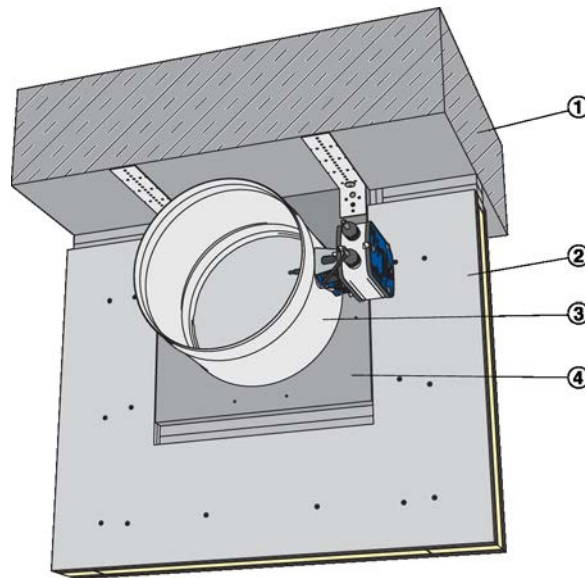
Einbau in Leichtbauwand und gleitender Deckenanschluss mit Einbausatz GL
